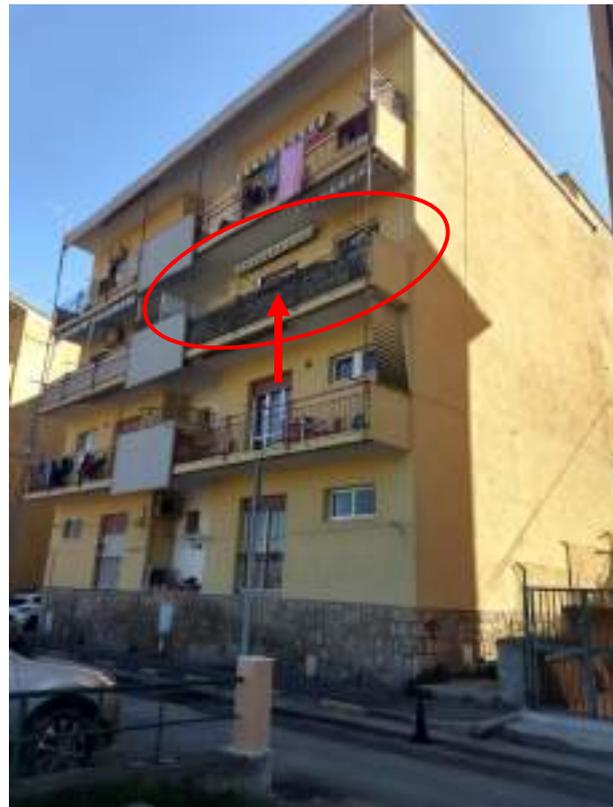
Vista del fronte principale del fabbricato prospiciente la Via Argentiera.
